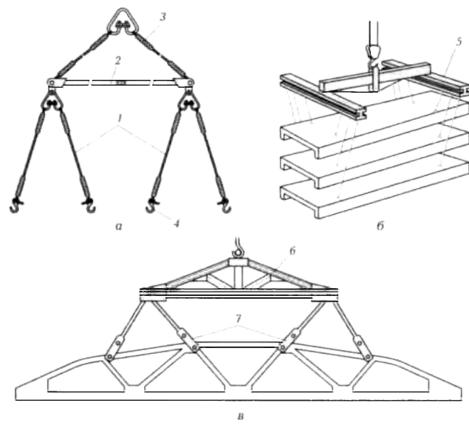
Траверсы: а – балочная с двухветвевыми стропами; б – балансирная с коромыслами для подъема плит; в – балансирная решетчатая для монтажа ферм; 1 – канатный строп; 2 – балки; 3 – разъемные подвески; 4 – крюк; 5 – коромысло; 6 – треугольная ферма; 7 – жесткие стропы
